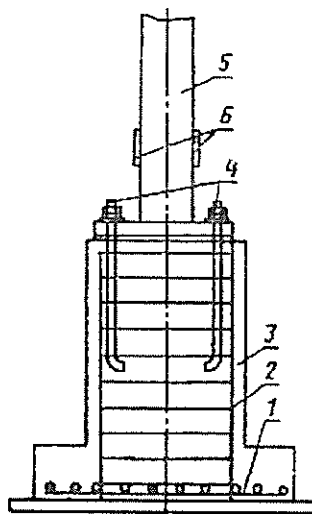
Соединение металлической колонны с арматурой железобетонного фундамента:
